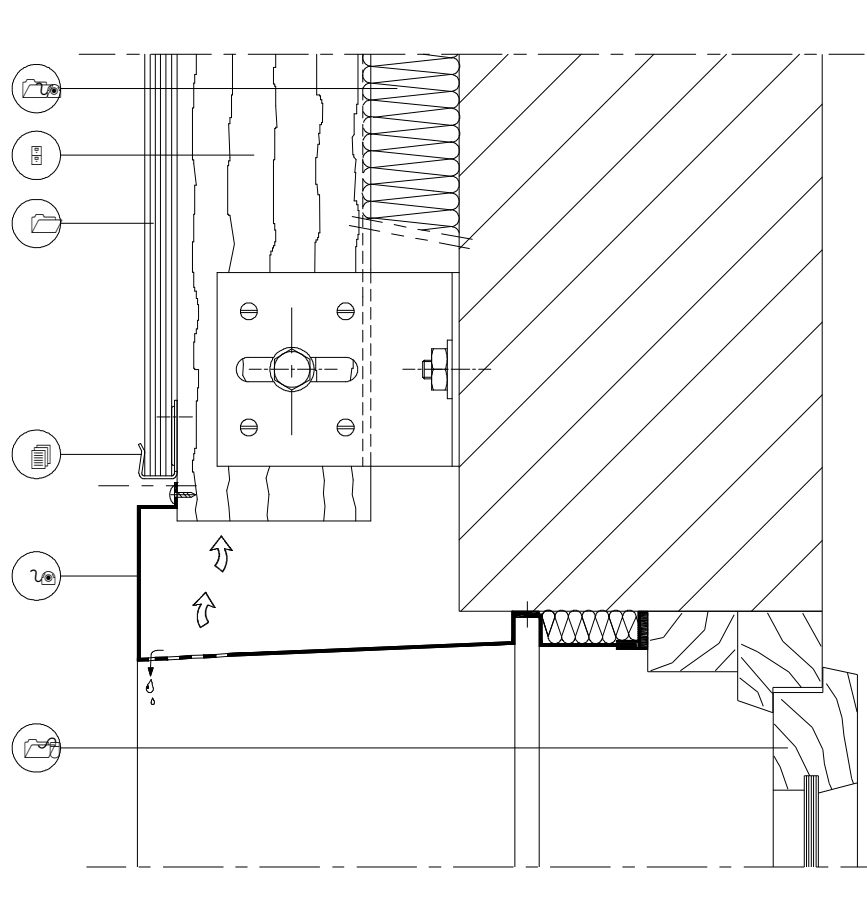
Linteau de baie – Coupe verticale – Ossature bois
